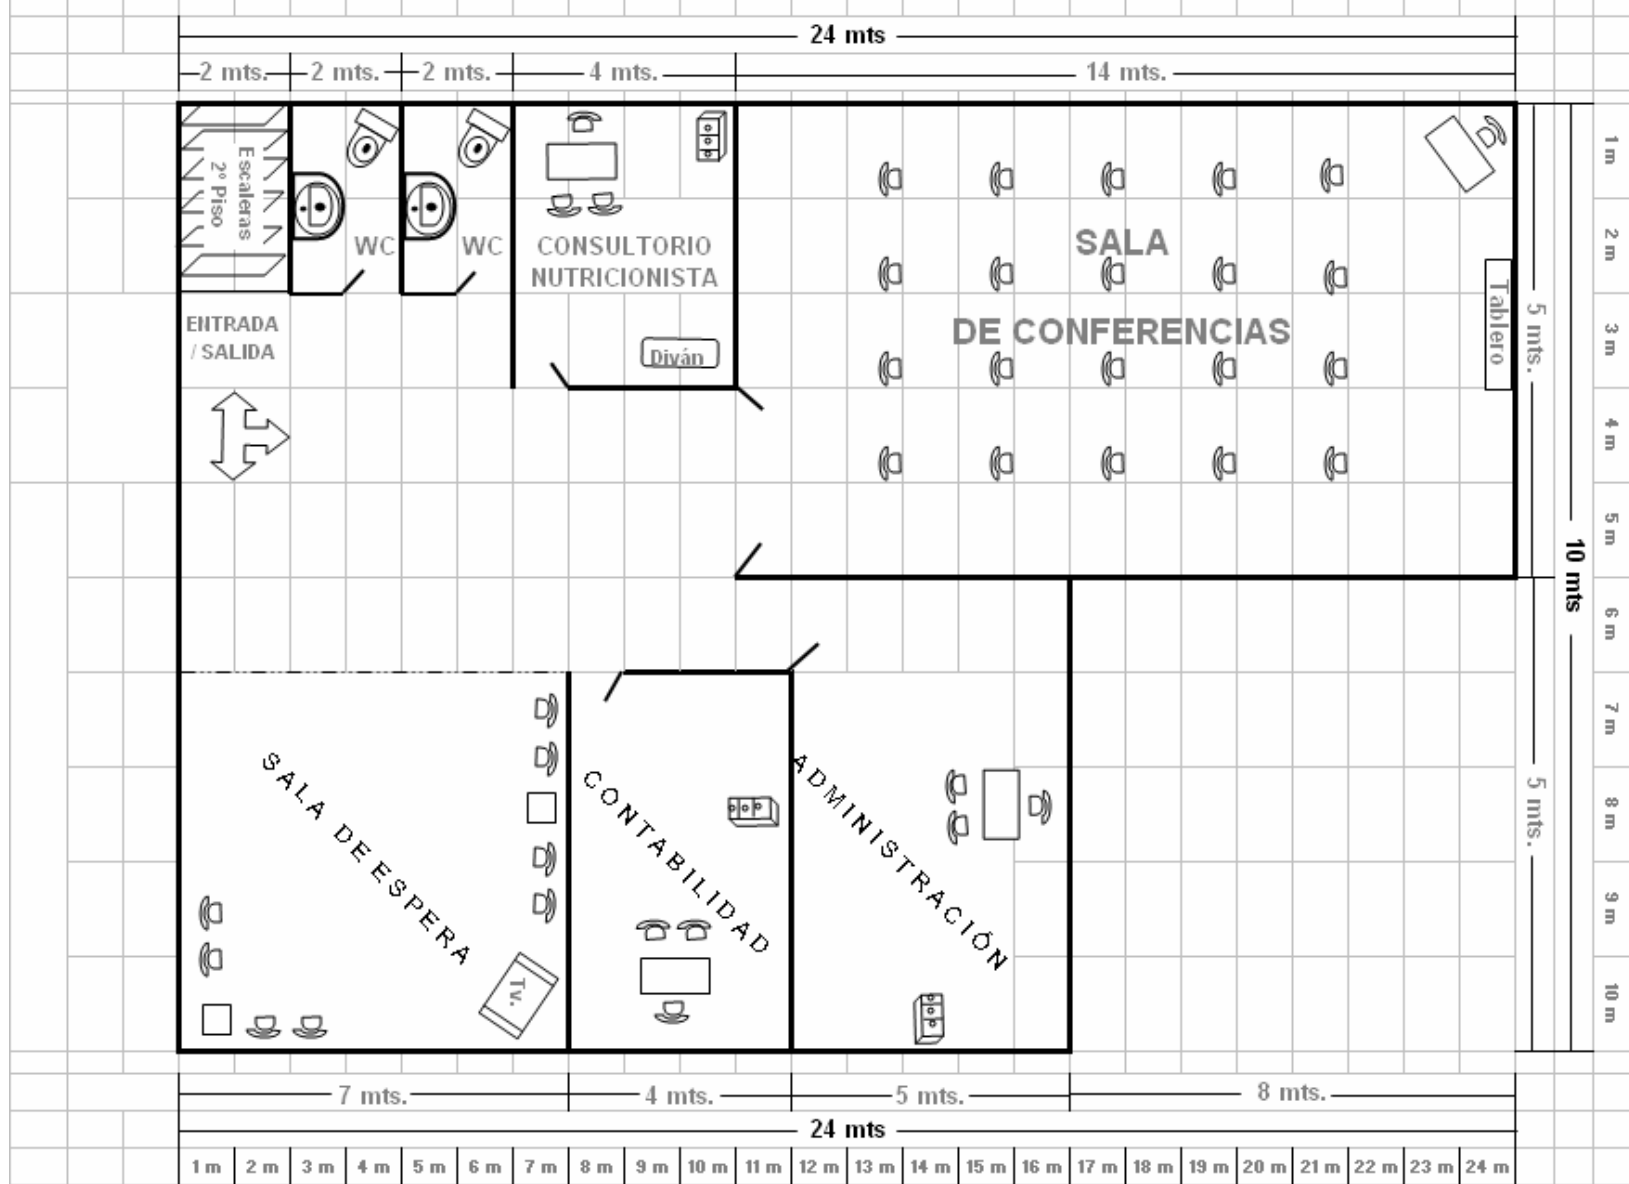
Plano Distribución de Planta "Restaurante La Cocina Saludable"- 2º Piso
